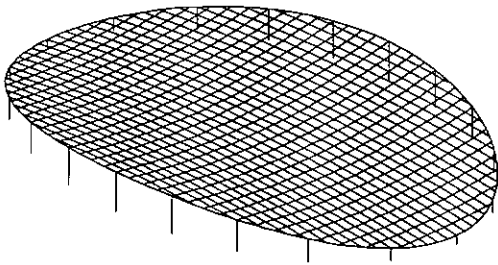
b Malha de cabos ancorados em anel de contorno em planta e pilares.
